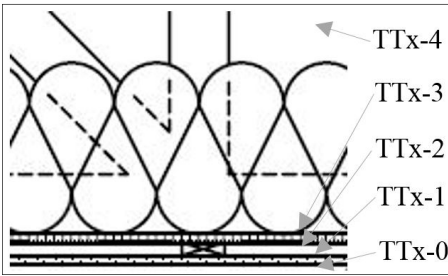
Mur de fondation et du plancher du sous-sol (dalle de béton) avec les thermocouples
